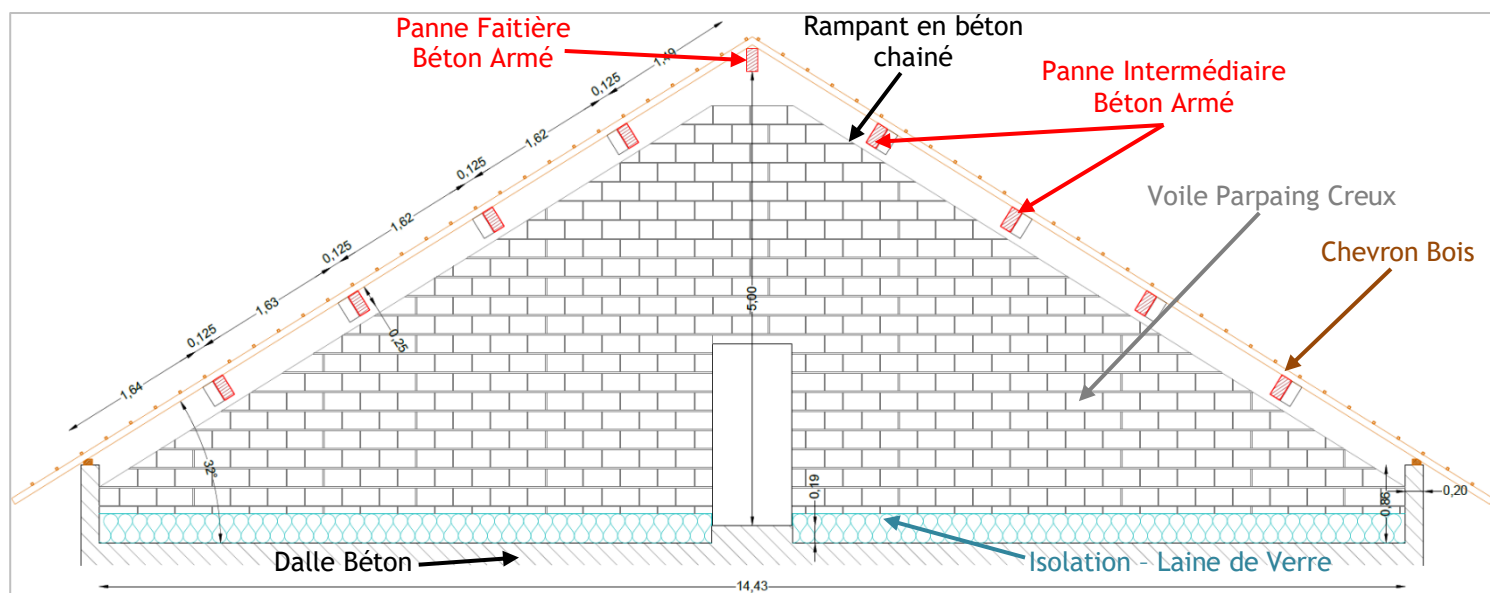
Coupe DD' transversale de principe de la charpente du bâtiment 13 (unités en m)
